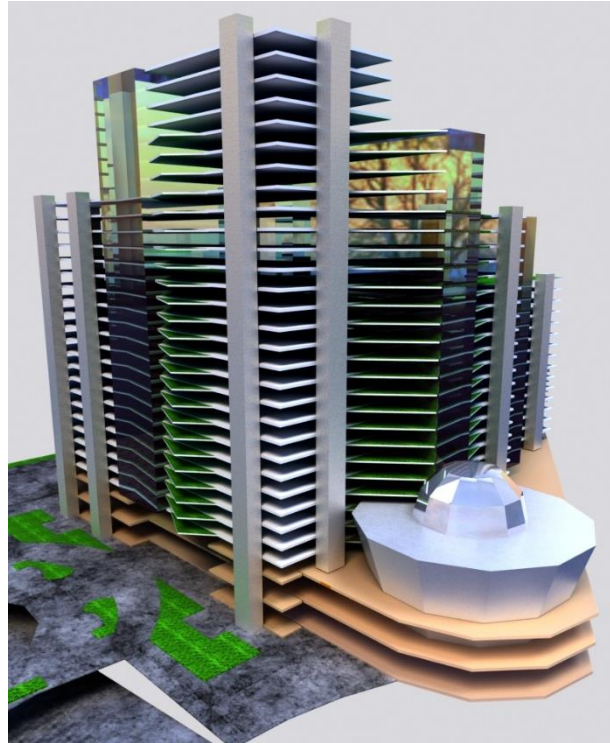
Render de proyecto arquitectónico fuente: elaborado por el autor
